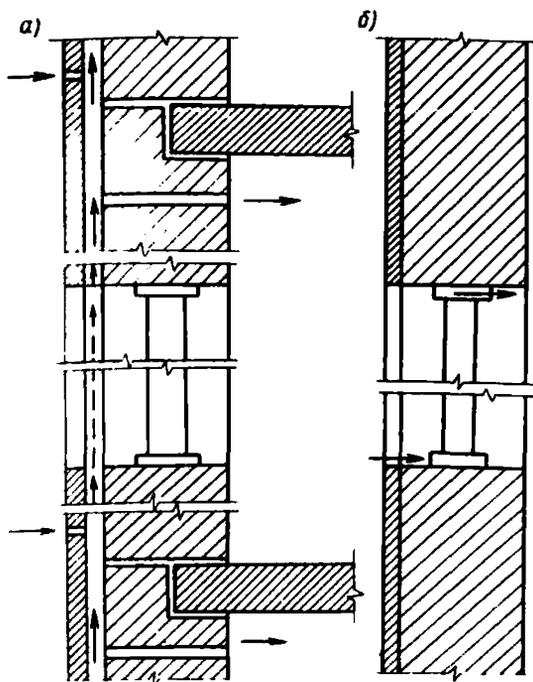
Принципиальная схема проветривания помещений при вентилируемых (а) и невентилируемых (б) наружных ограждениях с утепленными экранами
